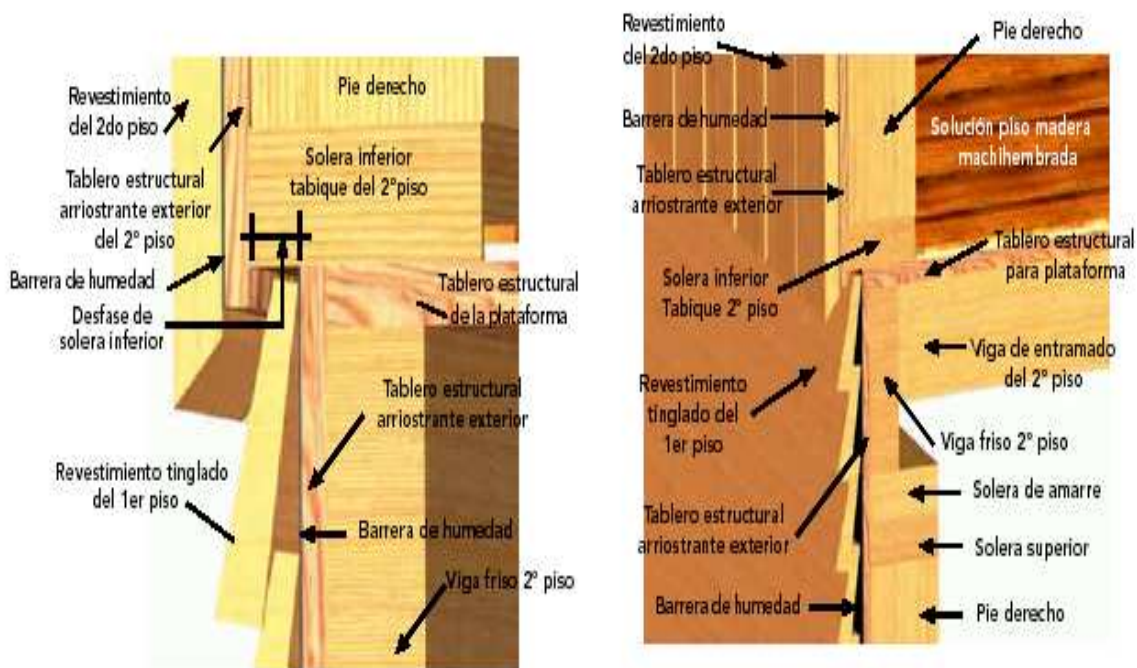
Detalle de solución constructiva para el encuentro del revestimiento entre dos niveles, desfasando la solera inferior de los tabiques perimetrales del segundo piso. Corte y vista en perspectiva del muro exterior con el revestimiento instalado
